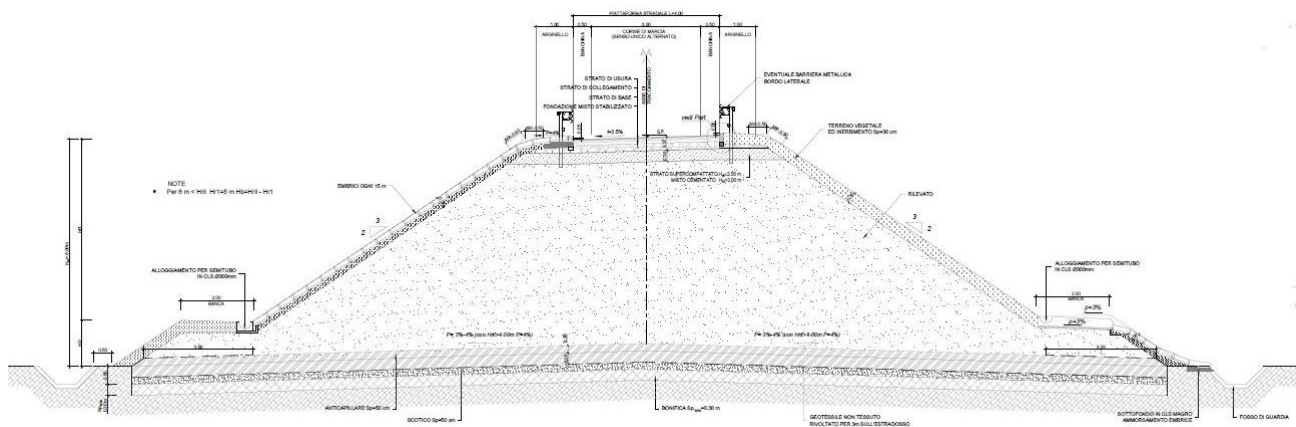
Dest. Particolare 4.0 m - sezione tipo in rilevato $H_{ril} > 6.00$ m
